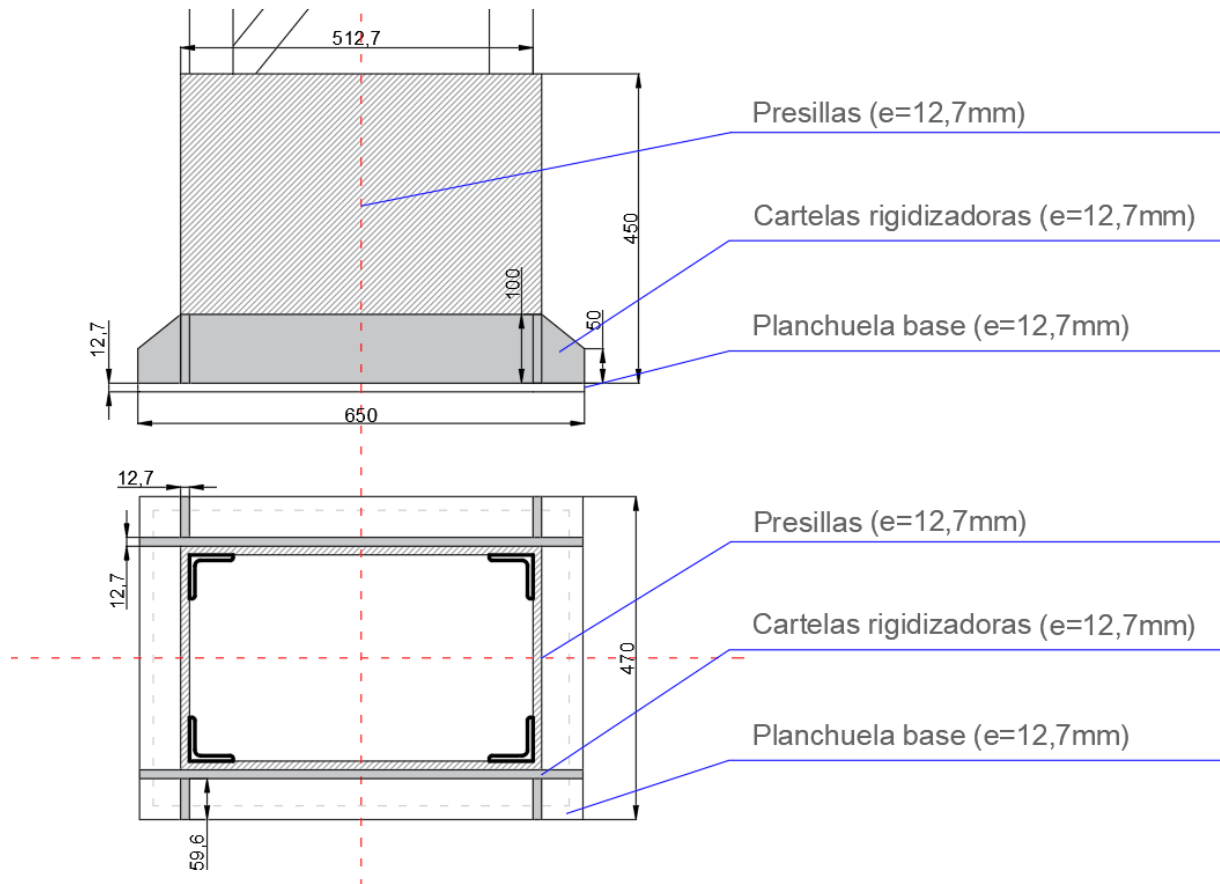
Detalle constructivo de la unión Columna metálica - Tronco de columna de H•A•
